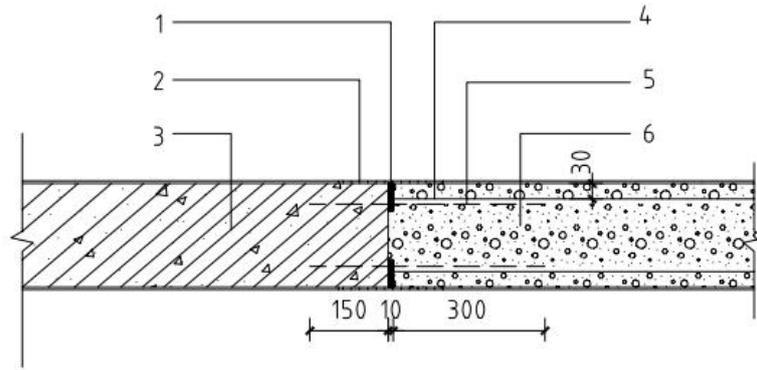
泡沫混凝土墙体与剪力墙连接示意
